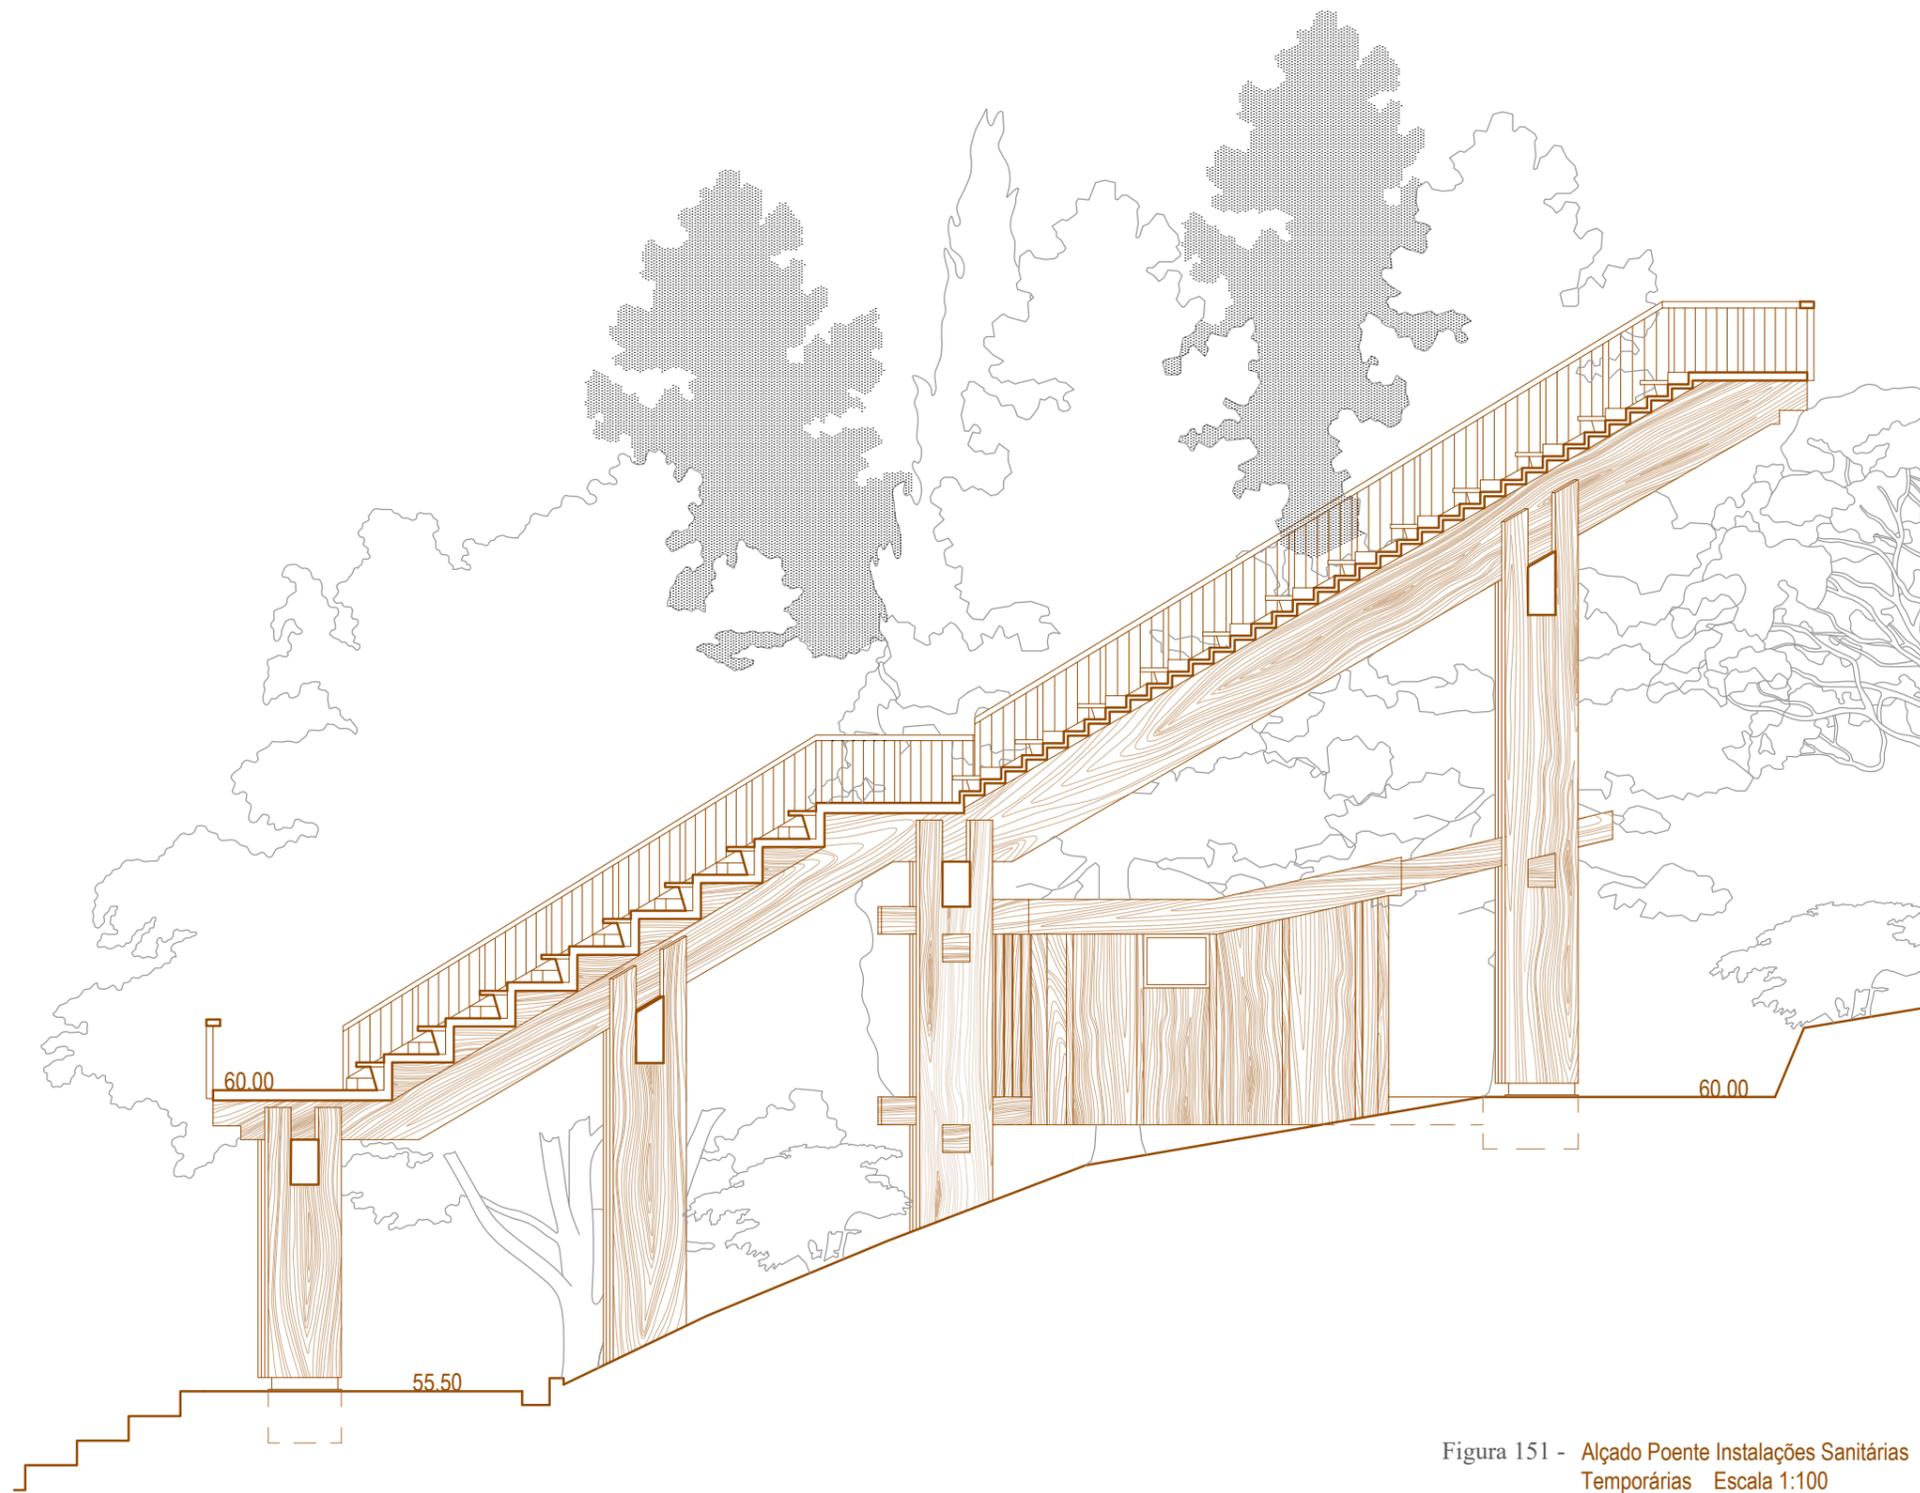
Alçado Poente Instalações Sanitárias Temporárias Escala 1:100
